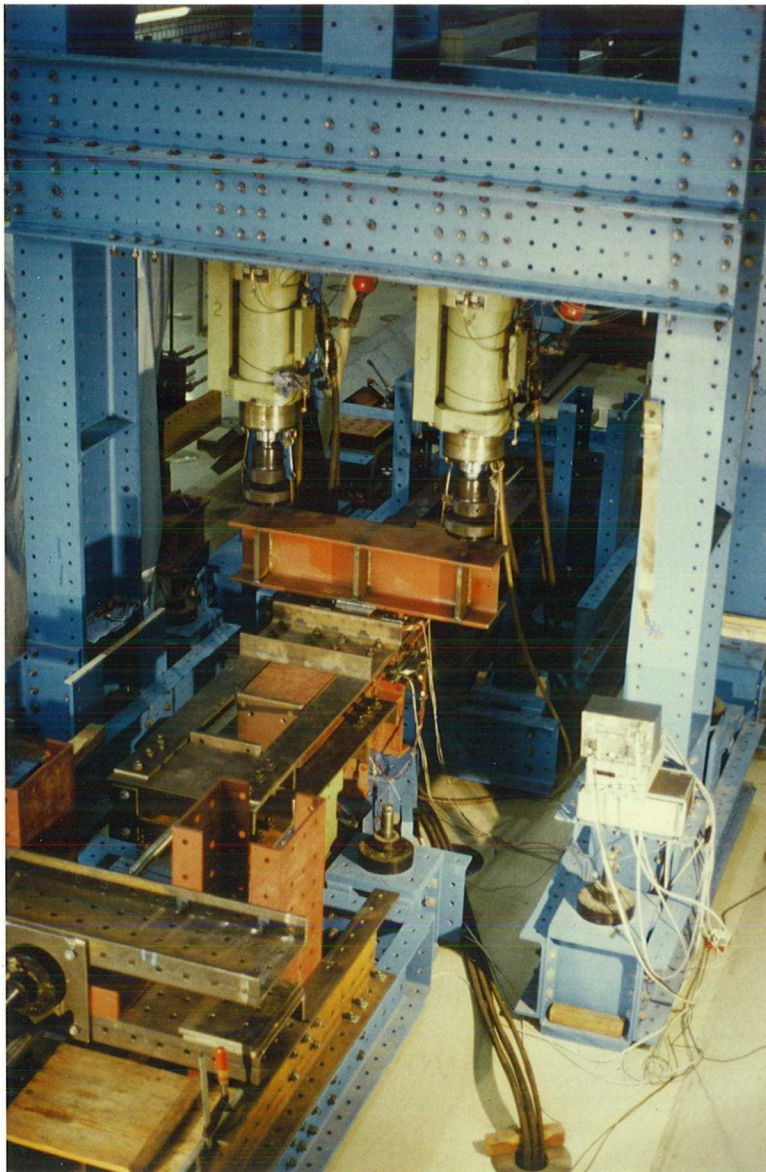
Belastungsrahmen mit Versuchsaufbau und eingebautem Prüfkörper
